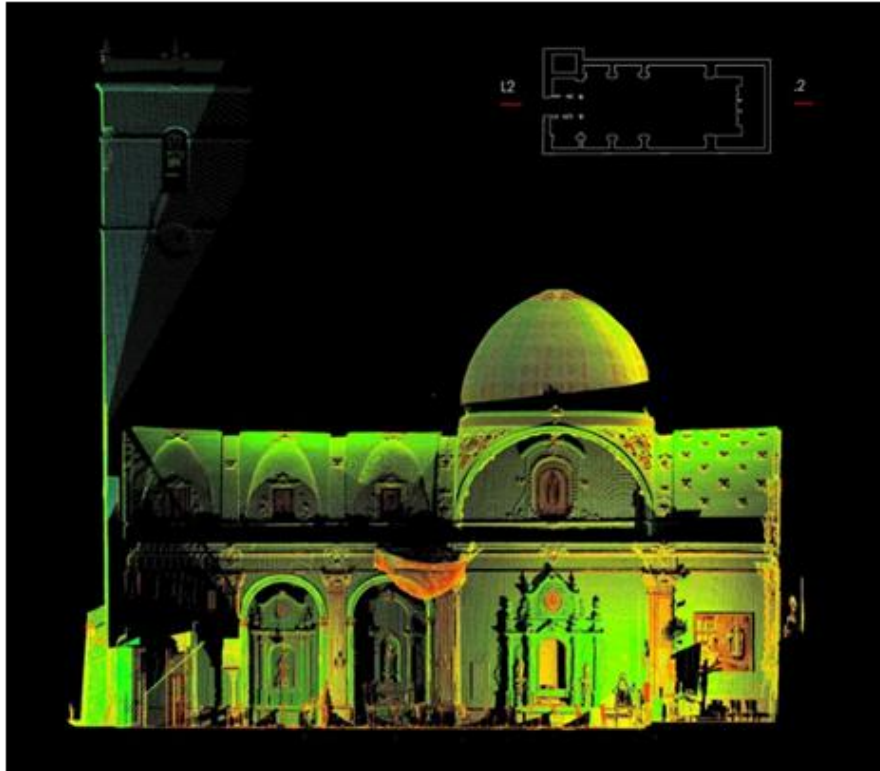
Levantamiento de la fachada de una iglesia con equipos láser escáner 3D
